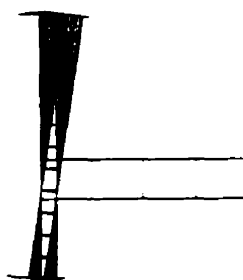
Poutre avec raidisseurs transversaux simples et raidisseur longitudinal, assemblage faible
